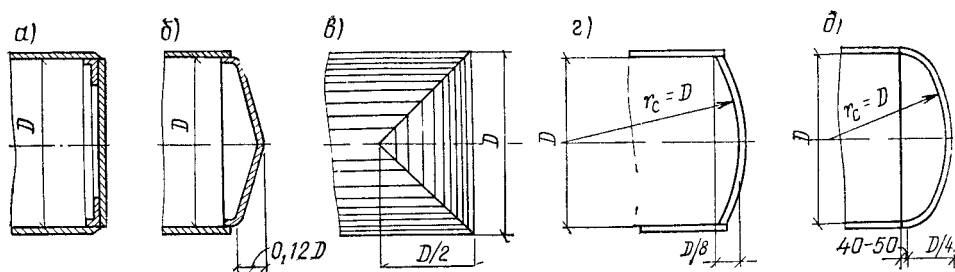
Типы днн горизонтальных цилиндрических резервуаров
